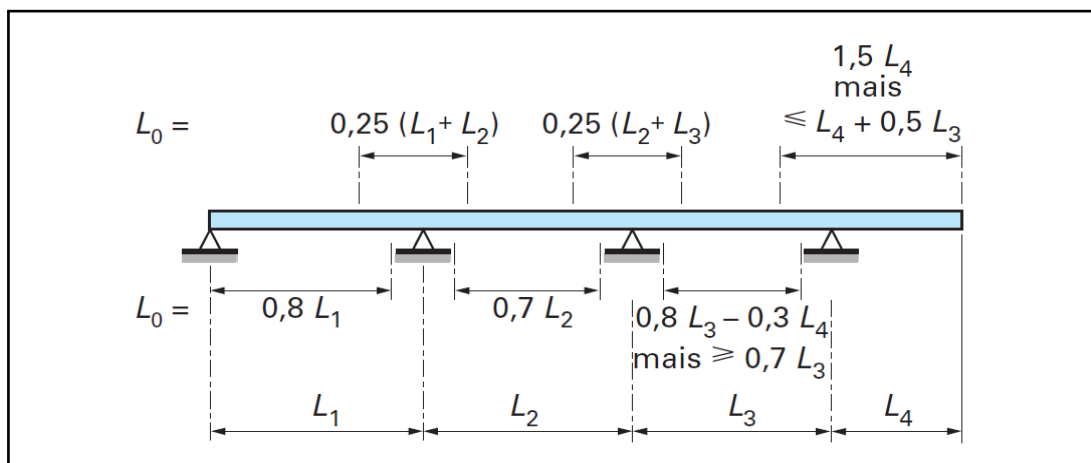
Largeur participante de dalle pour une poutre de plancher [4]
